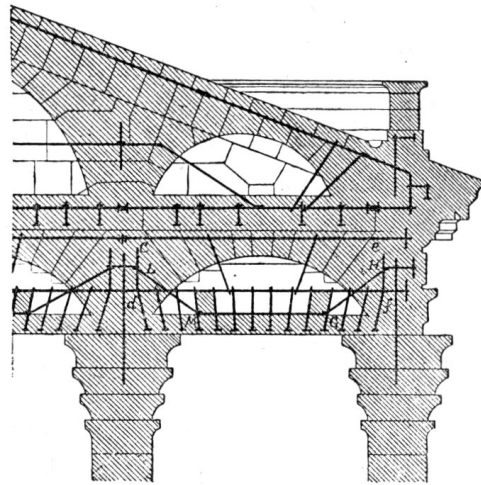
Coupe sur la pierre armée du Panthéon de Paris.
